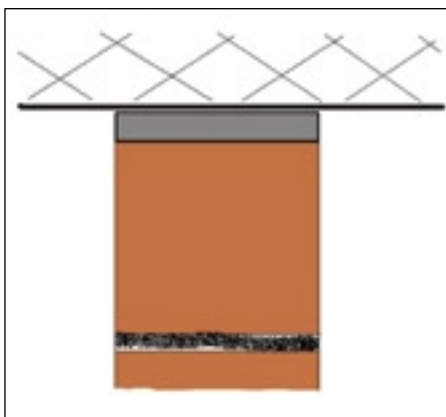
Korrekt ausgeführter Zementmörtel-Glattstrich. Er befindet sich unterkant Betondecke und greift in die Lochung der obersten Backsteinlage ein.
